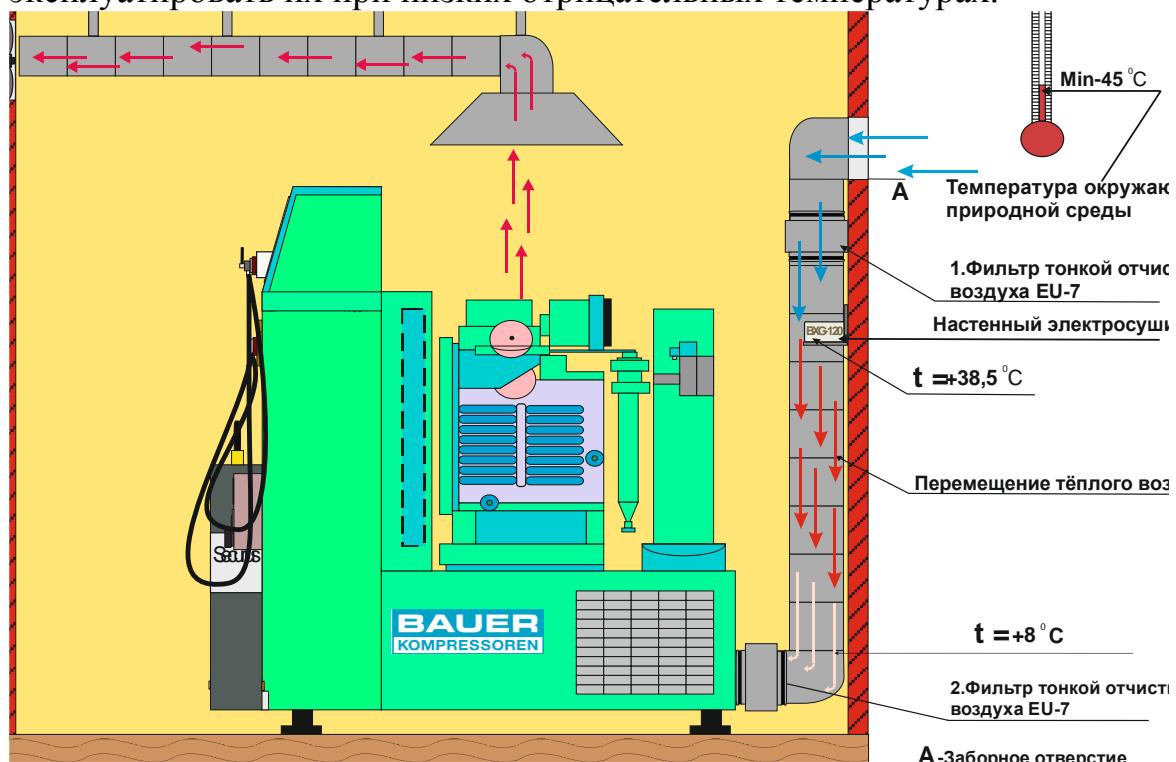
Схема движения холодного воздуха в компрессорную установку
